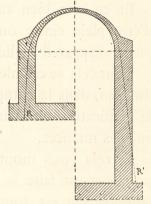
Stabilité et instabilité d'une même voûte, suivant la hauteur des piédroits.
